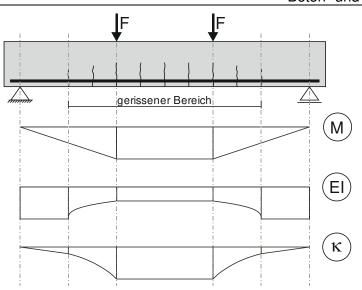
Schematische Darstellung des Momenten-, Biegesteifigkeits- und Krümmungsverlaufs eines gerissenen und bewehrten Betonbalkens im Vierpunktbiegeversuch
